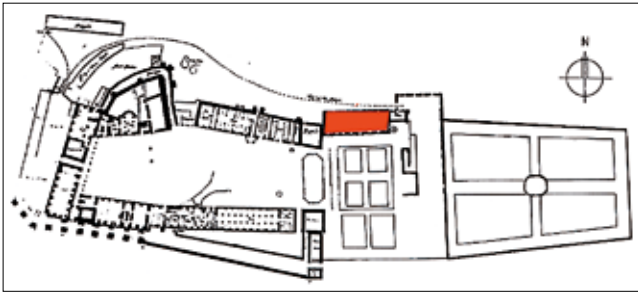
Grundriss der Schlossanlage, 18. Jh., Lage der Reithalle
